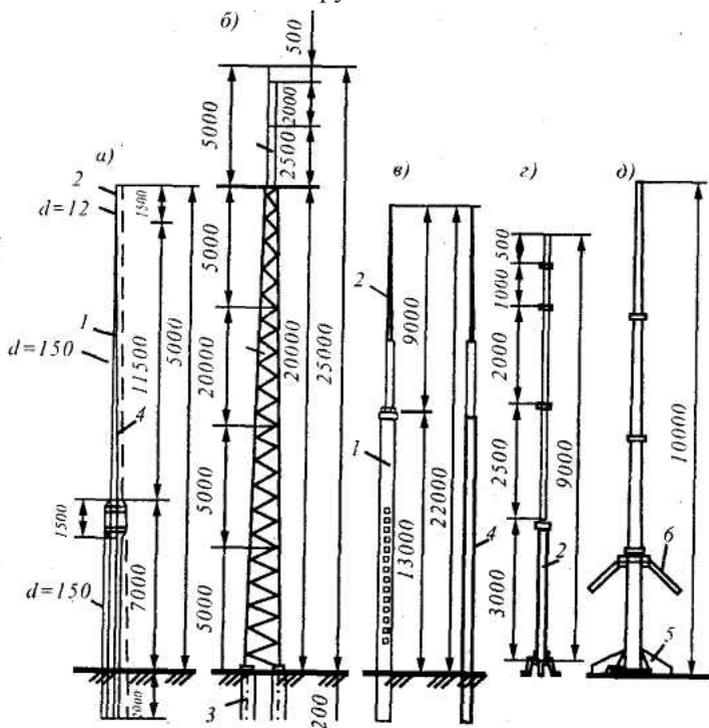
Конструкции стержневых молниеотводов и молниеприемников: а – на деревянной опоре; б – металлический решетчатый М-25; в – на железобетонной опоре; г – молниеприемник железобетонного молниеотвода; д – из газовых труб, устанавливаемых на крыше; 1 – опора (стойка); 2 – молниеприемник; 3 – подножник; 4 – токоотвод (спуск); 5 – фланец; 6 – оттяжка
